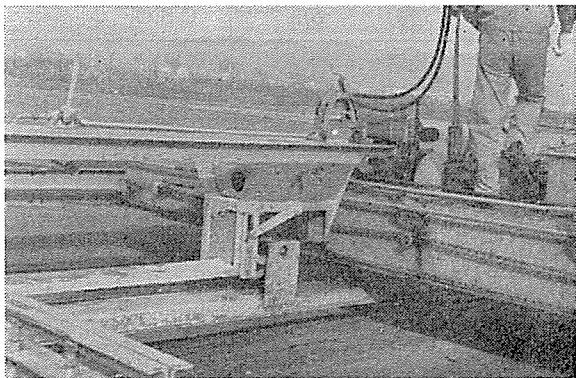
ロンジチュジナルフィニッシャによるコンクリート表面仕上げ
